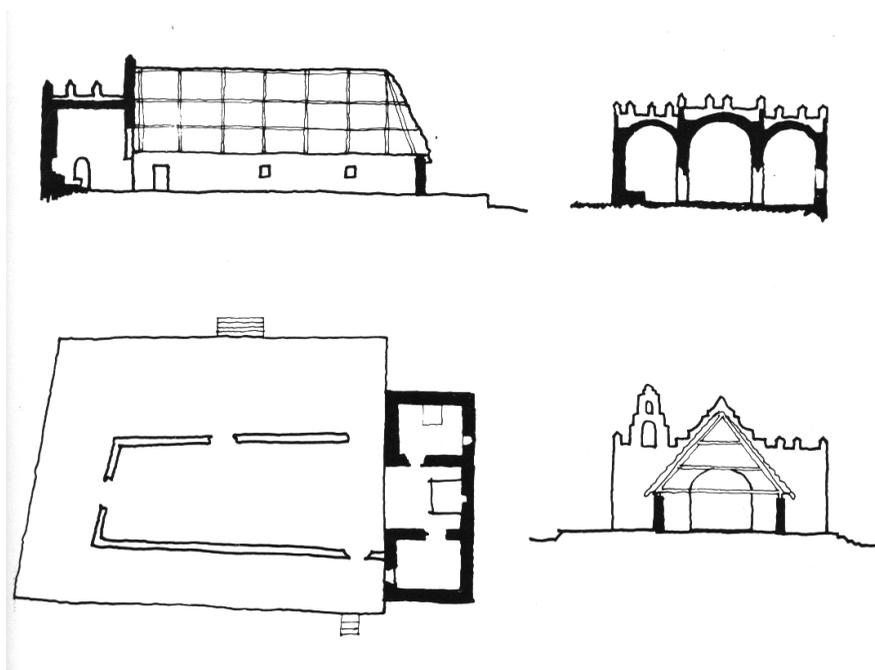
Planta de Boca, cortes y fachada en donde se aprecian las dos dependencias a cada lado del presbiterio y la ubicación de la ramada.
